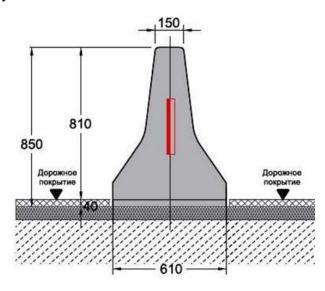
Эскиз типовой конструкции дорожного отбойника
